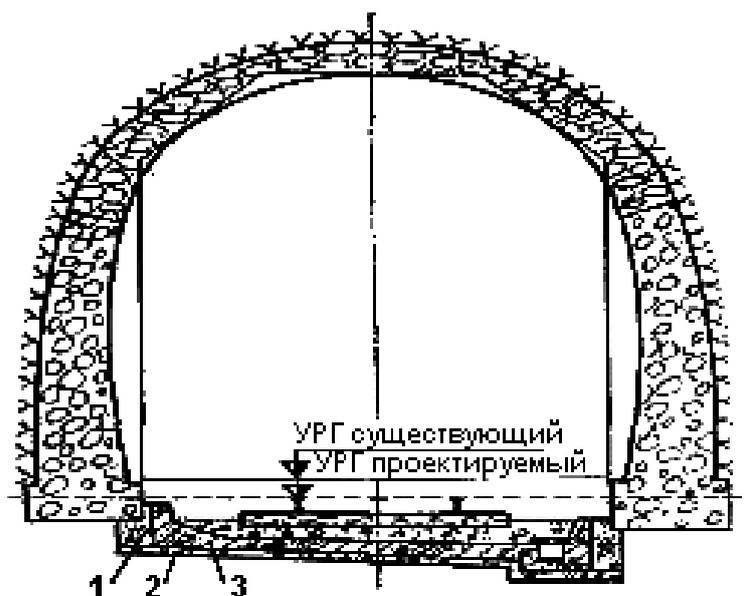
Конструкции распорной плиты при понижении пути: 1 – жесткий бетон; 2 – щебеночная подготовка, залитая цементно-песчаным раствором; 3 – железобетонный блок распорной плиты длиной 1,25 м
